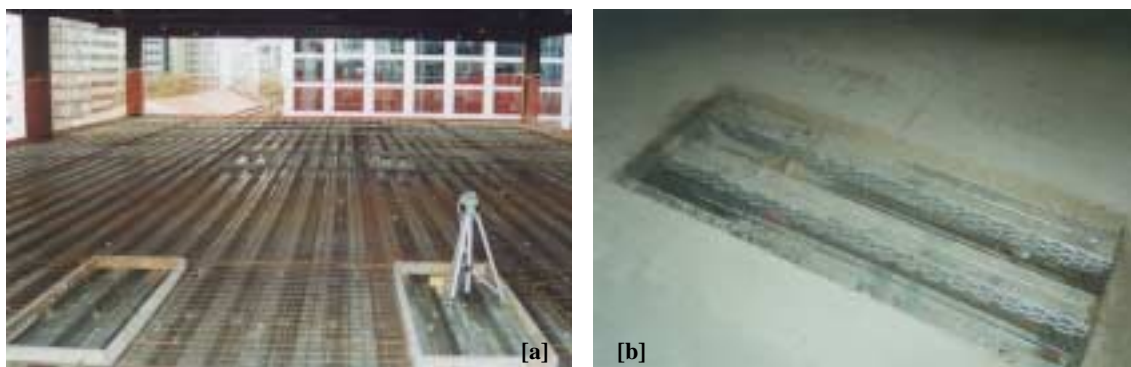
Vistas da laje, na região do *shaft* do andar-tipo: (a) antes da concretagem; (b) após a cura do concreto.
